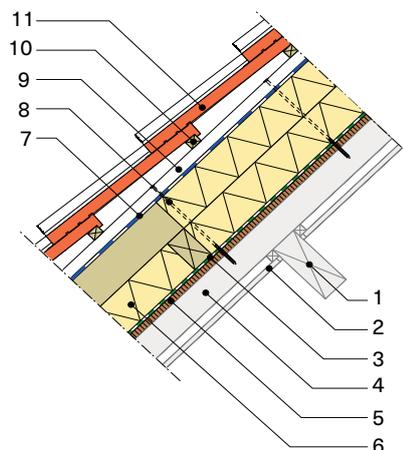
Toiture sarking avec plancher de toiture (vue 2D).
